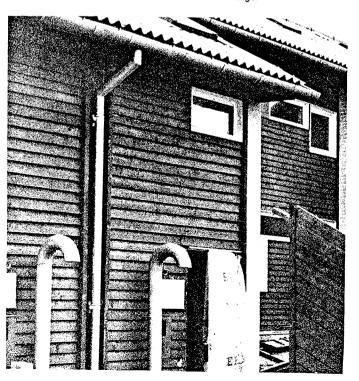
Præfabrikerede lette træfacader. Montagebyggeri er andet end beton, her ses hele lette præfabrikerede træfacader klar til montage.
